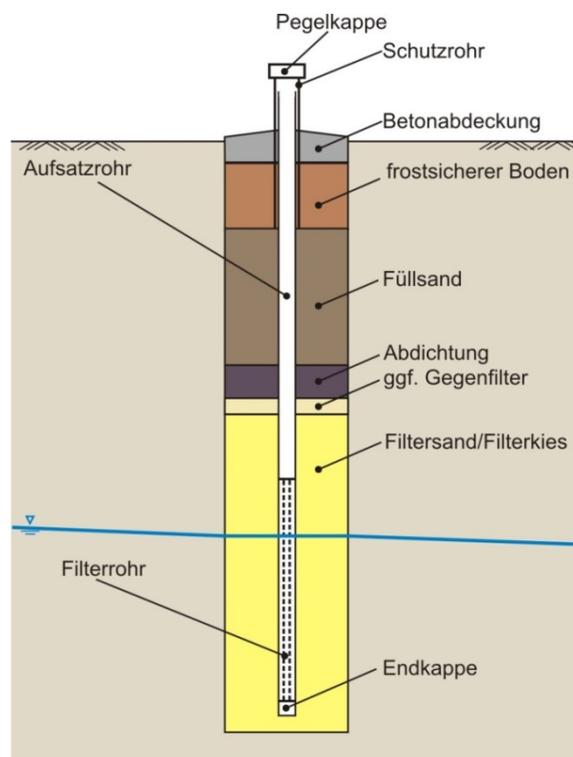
Ausbau Grundwassermessstelle mit Überflurmessstellenabschluss (Beispiel)
